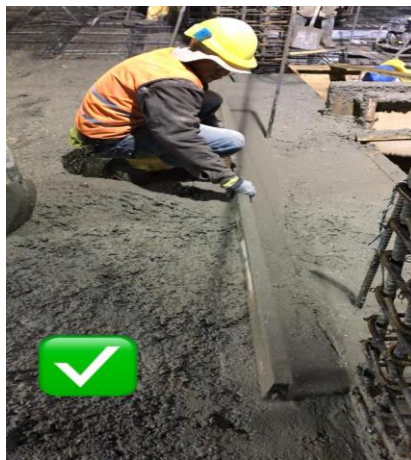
Posturas adecuadas para el alisado de la losa.
